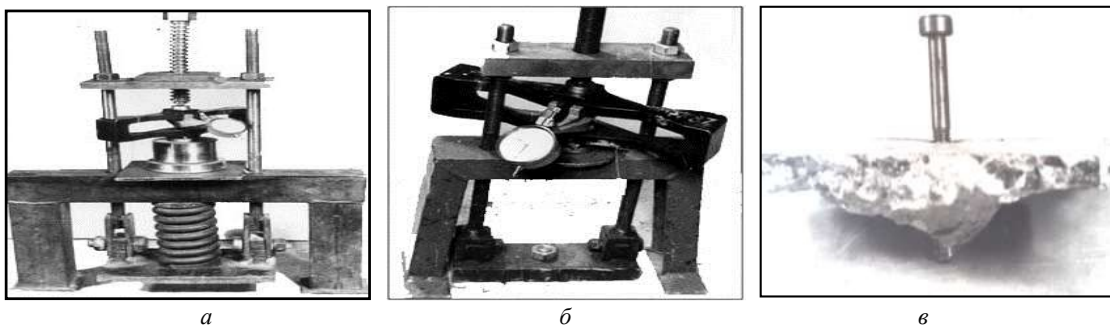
Устройство для испытания анкерных болтов А.С.№1638385:
